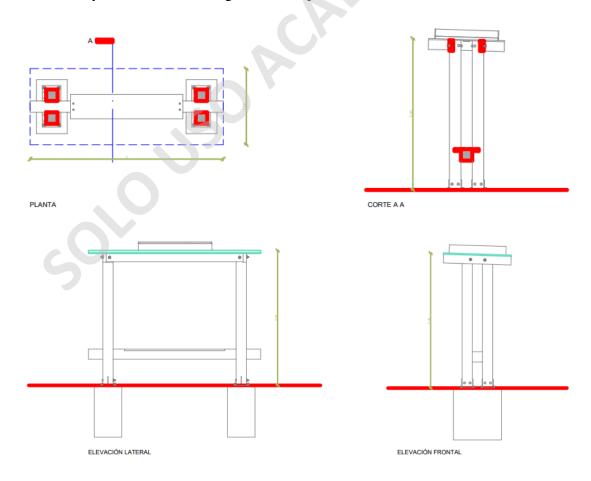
Nicolás Arriaza, Marzo 2023, Vista con los cimientos de Refugio Sustentable modelo planimetría propuesta elaborado en AutoCAD 2022
